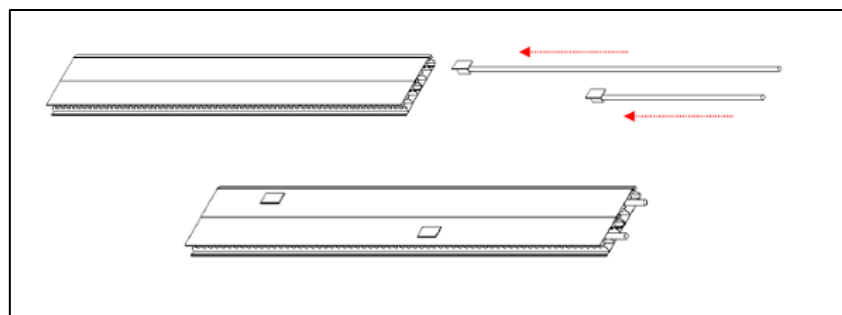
Ilustração da montagem das instalações elétricas em bancada, antes da montagem das paredes. Detalhe da inserção dos eletrodutos no painel de PVC rígido com as caixas de luz já fixadas nas extremidades. (Sem escala).
